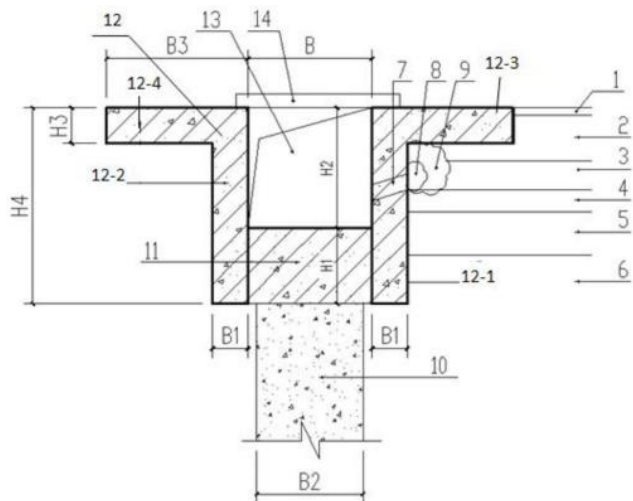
水平防渗与垂直防渗组合结构的施工方法设计的组合防渗结构剖面图
